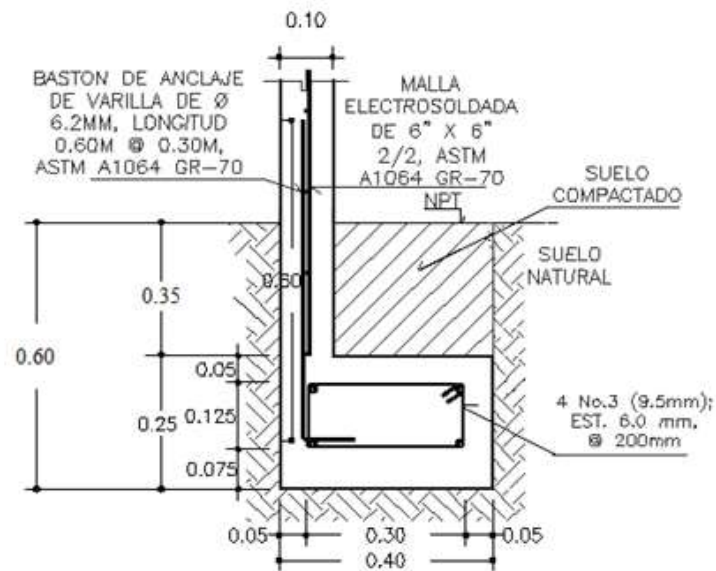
d Detalle típico de solera de fundación vivienda de dos plantas
